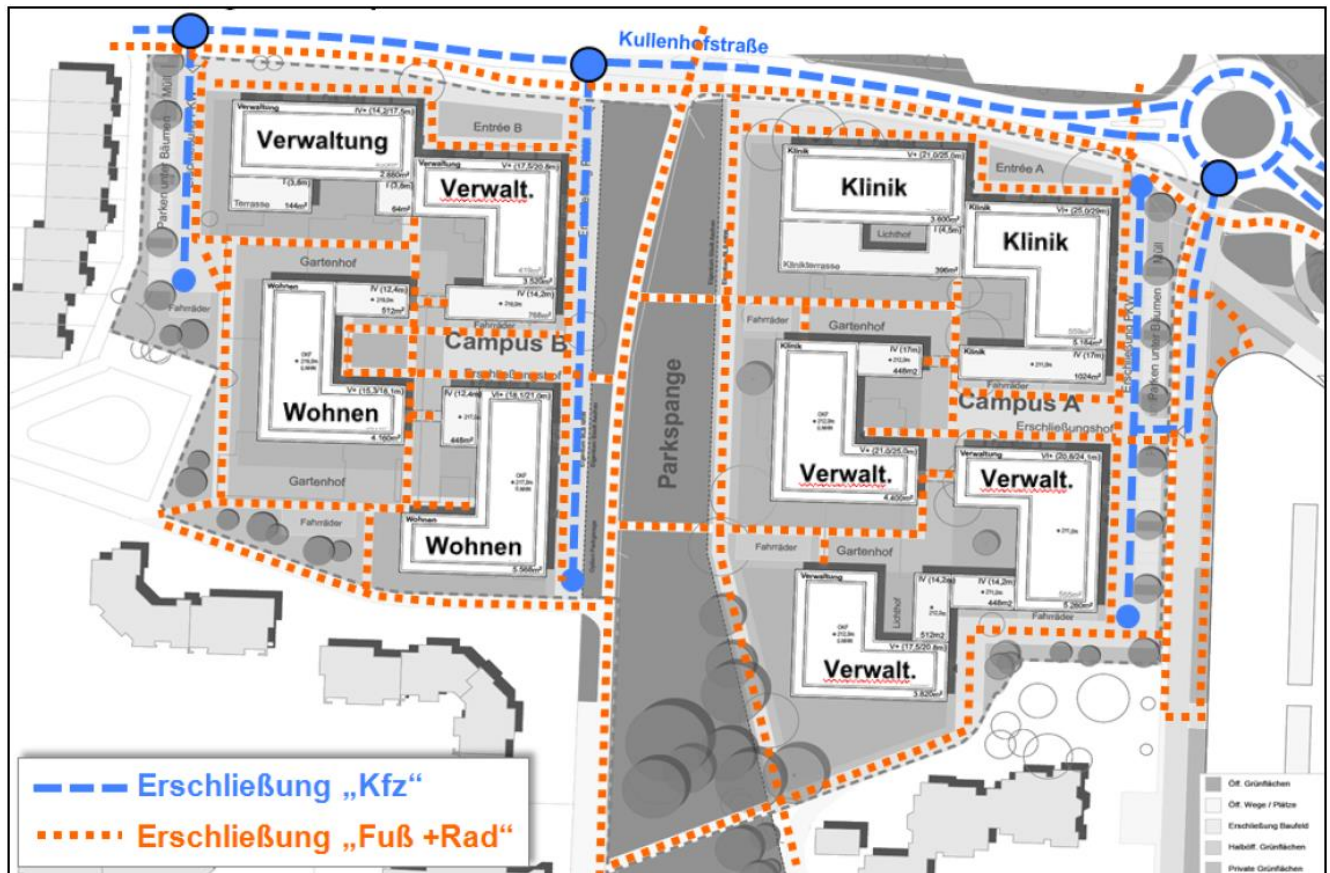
Erschließungskonzept auf Grundlage des städtebaulichen Vorentwurfs für den alten B-Plan 977 (Stand: 17.08.16)
